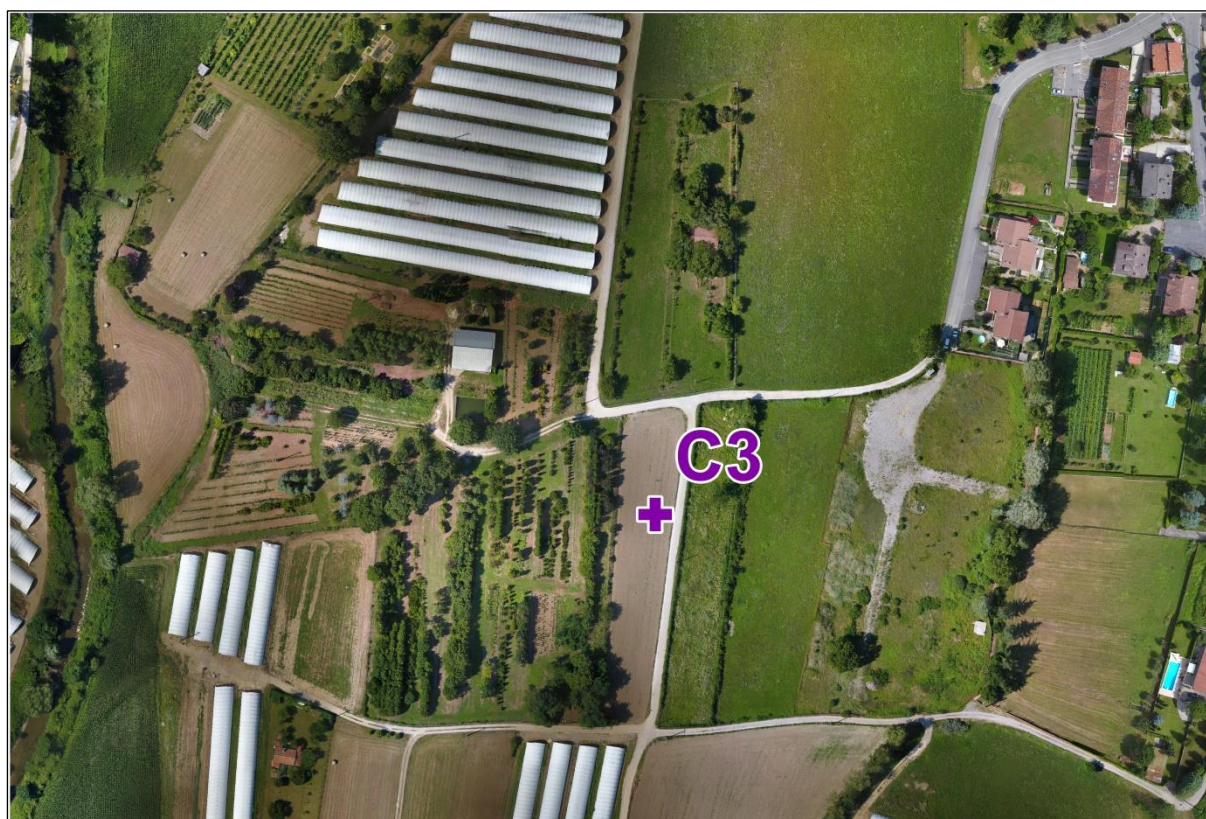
Ubicazione su base ortofoto di dettaglio del campione C3 di terre e rocce da scavo
